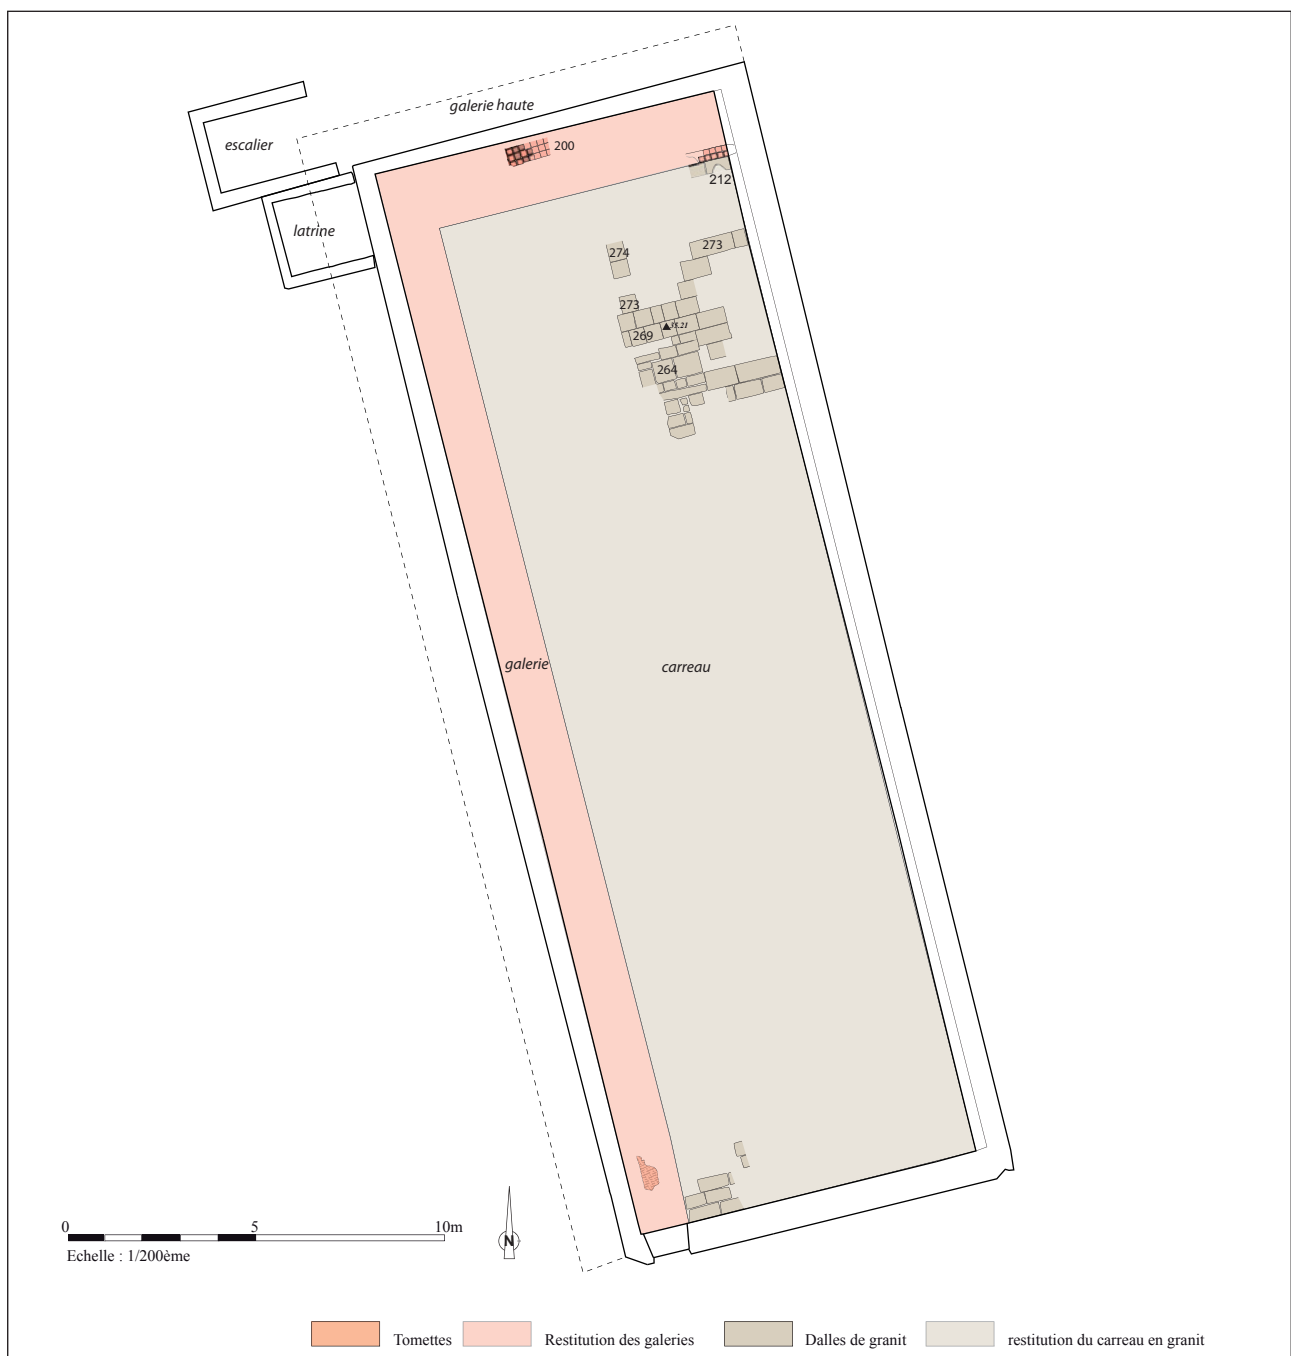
Le plan restitué du rez-de-chaussée © Elen Esnault, Inrap
